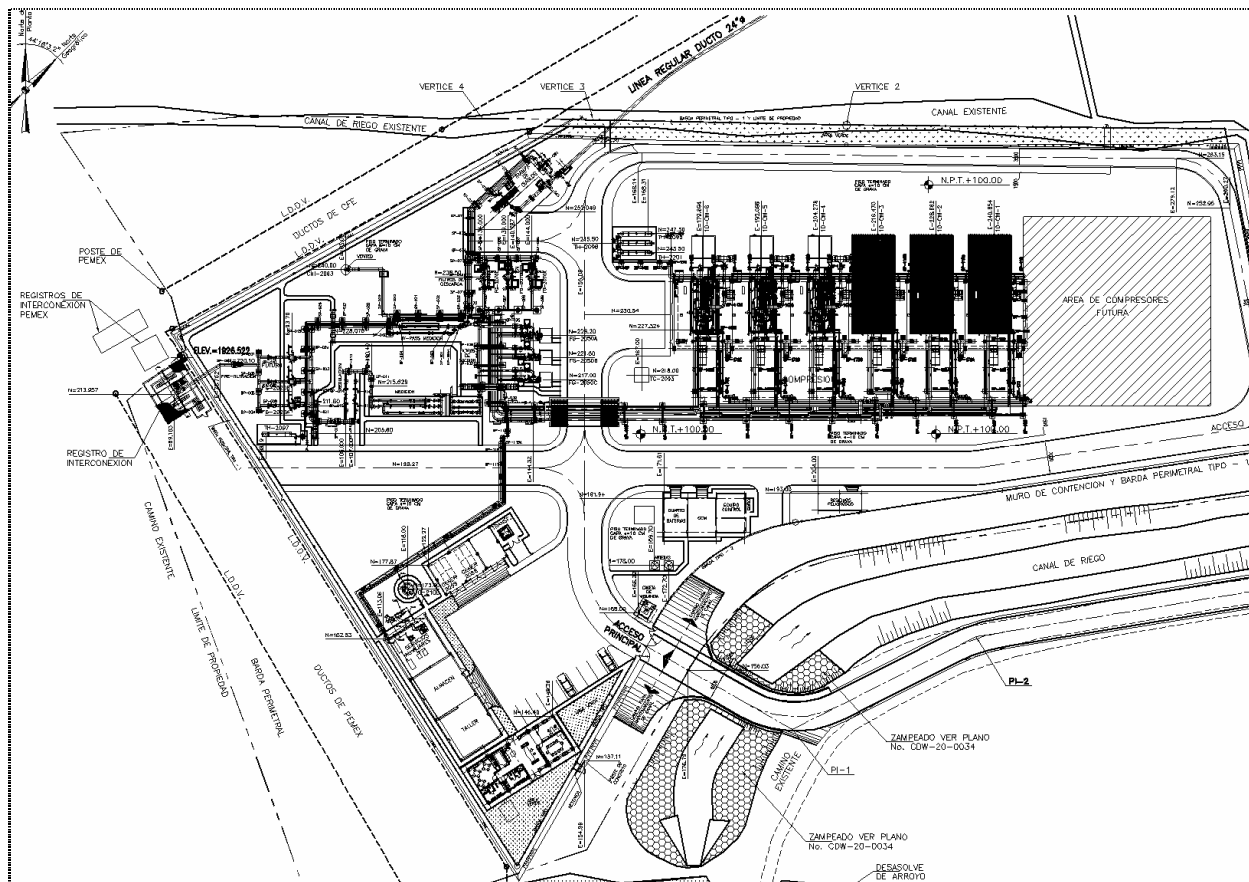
Plano General de la Estación de Compresión “El Sauz”
